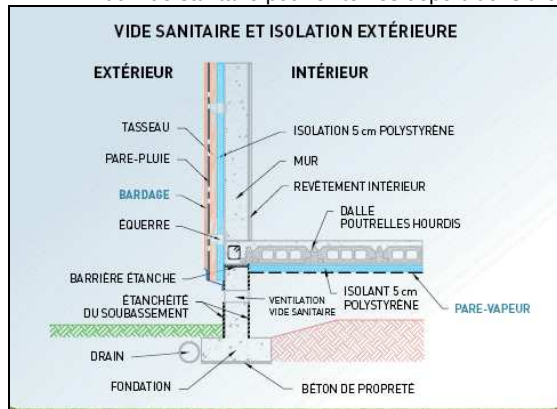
coupe d'isolation dallage sur vide sanitaire en zone 3 et 4 – à noter le pare vapeur doit se placer côté chaleur, donc à replacer sur le schéma côté dalle de l'isolant
